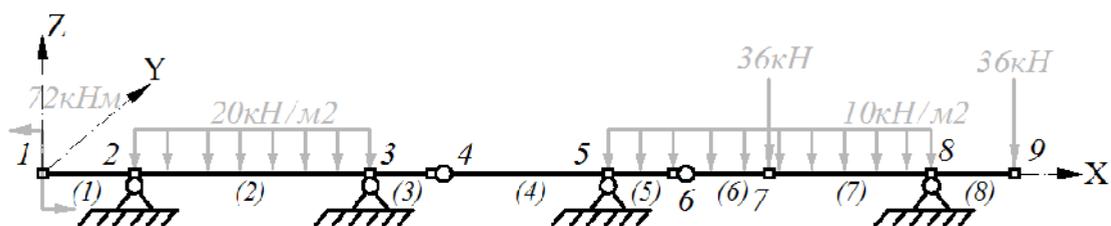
Предварительно подготовленная расчетная схема шарнирной балки
